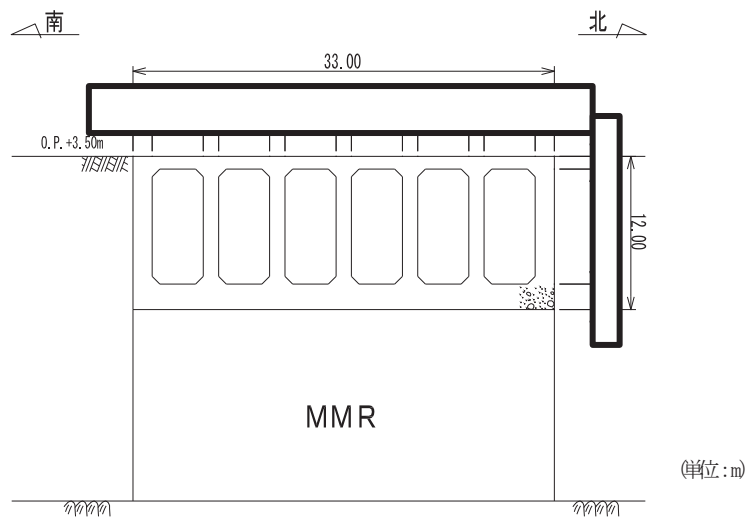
取水口断面図 (A-A 断面, 南北 (標準部))
